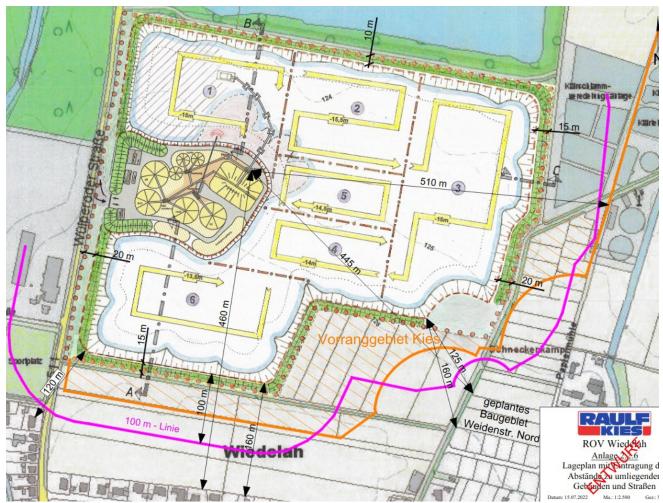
Lageplan des geplanten Bodenabbaus mit den maßgebenden Abständen zur Wohnbebauung
